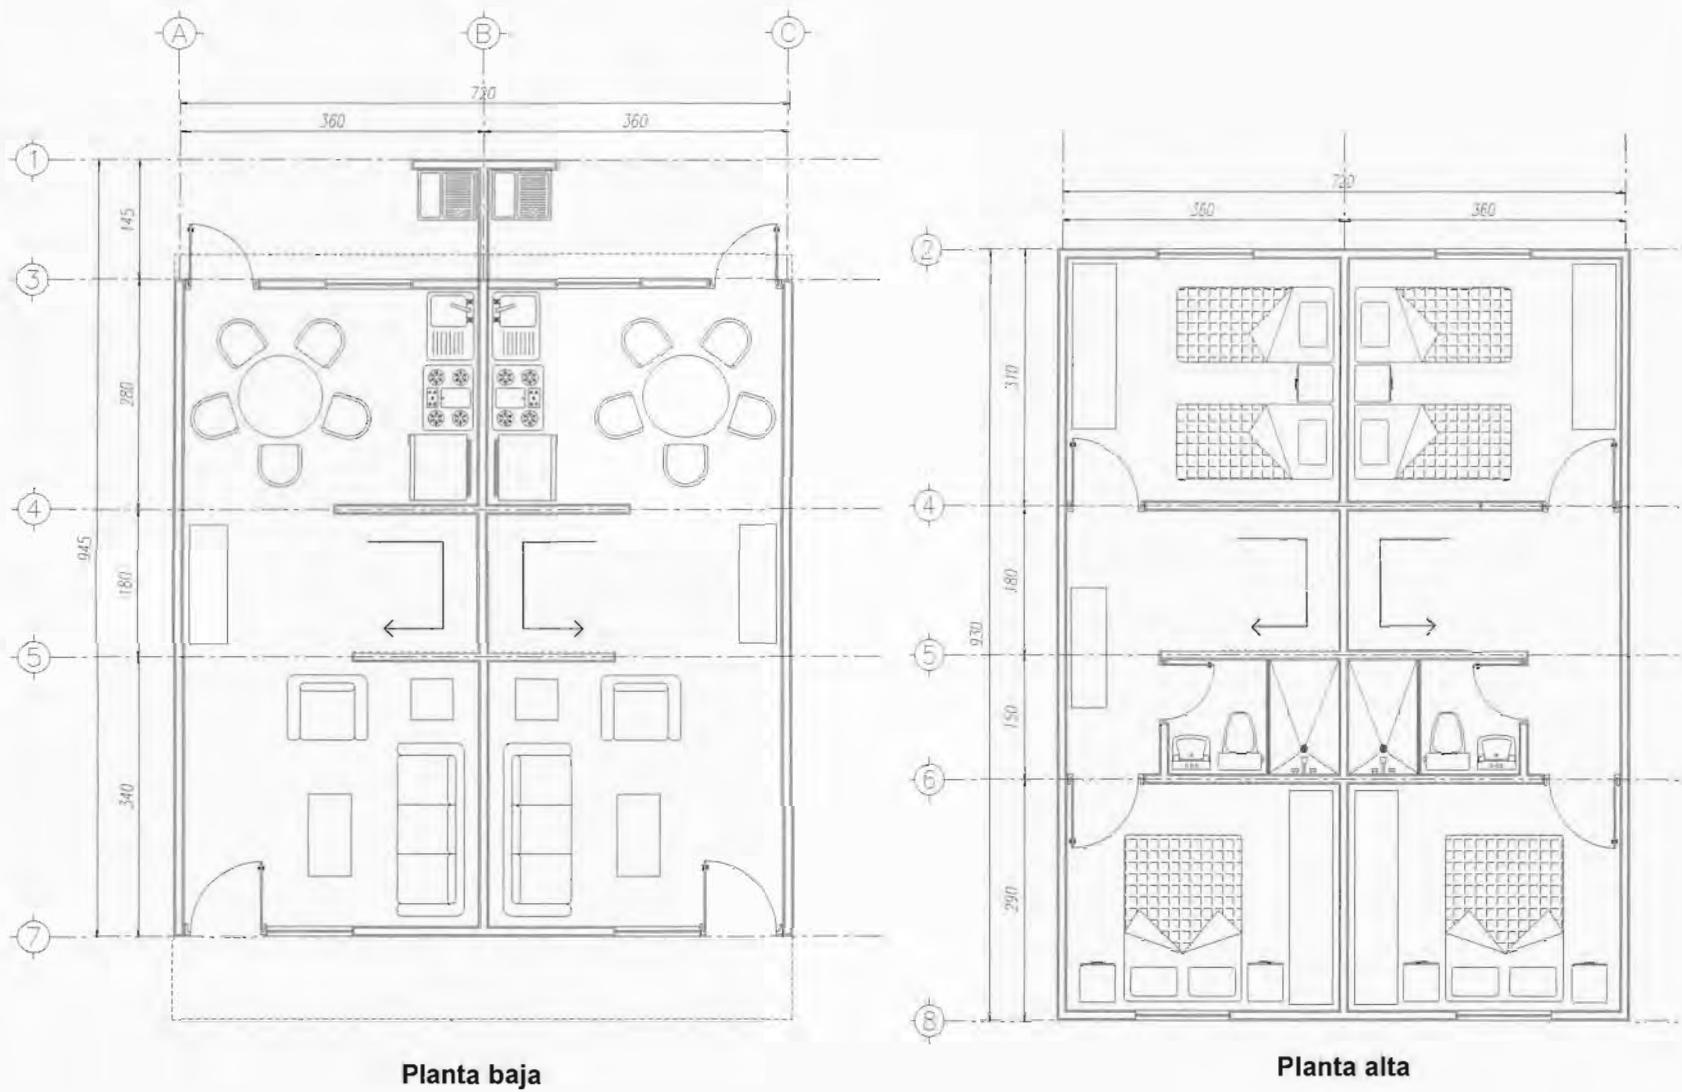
Planta arquitectónica prototipo Rancho Victoria
